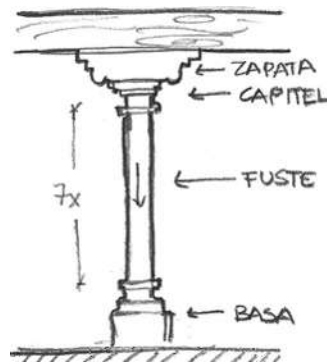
Croquis de sistema constructivo de apoyos aislados. Elaboró: METR
